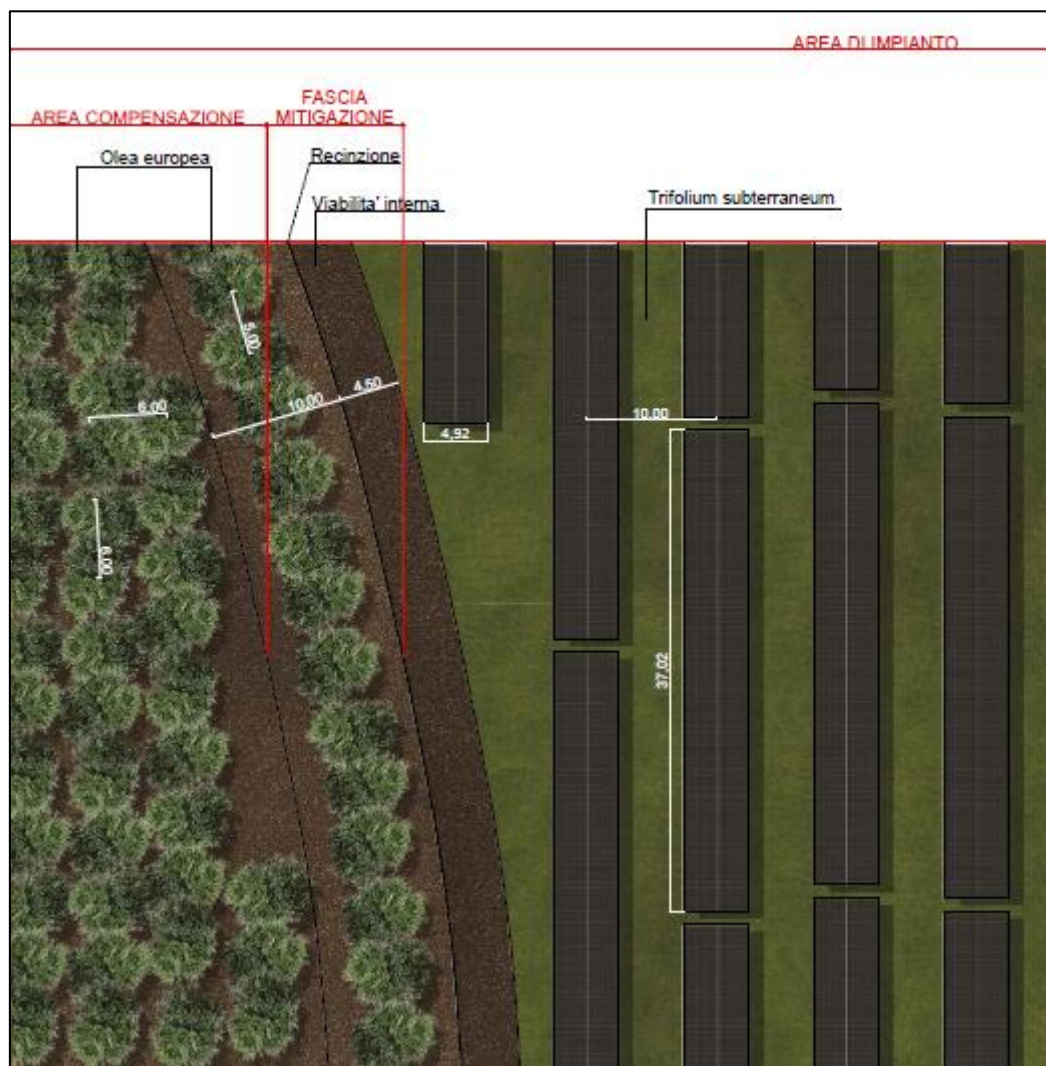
planimetria dell'area di impianto e di una delle aree di compensazione destinate all'impianto di ulivi.
